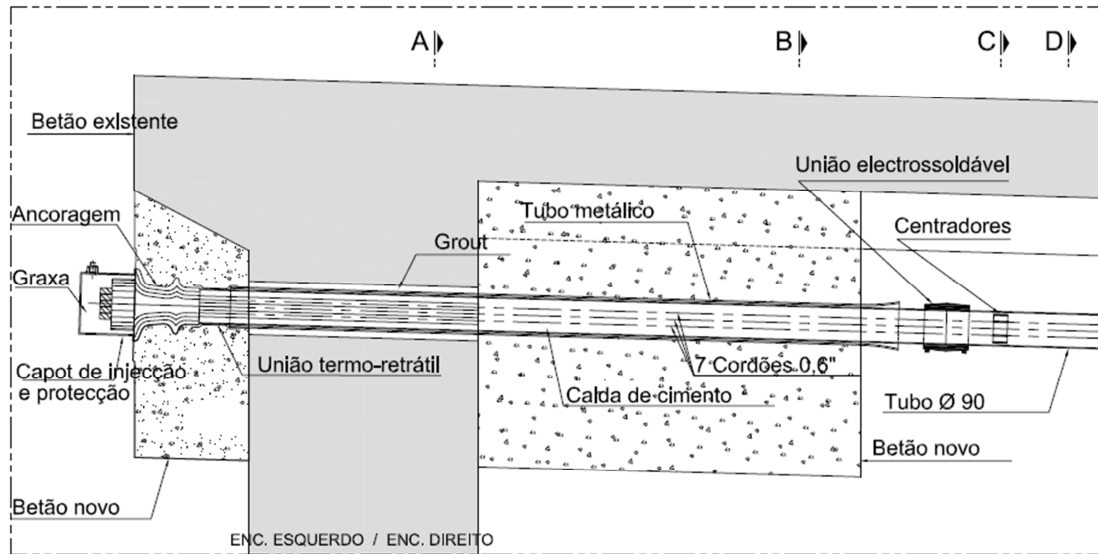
Pormenor da amarração dos cabos de pré-esforço exterior na extremidade sobre o encontro.
